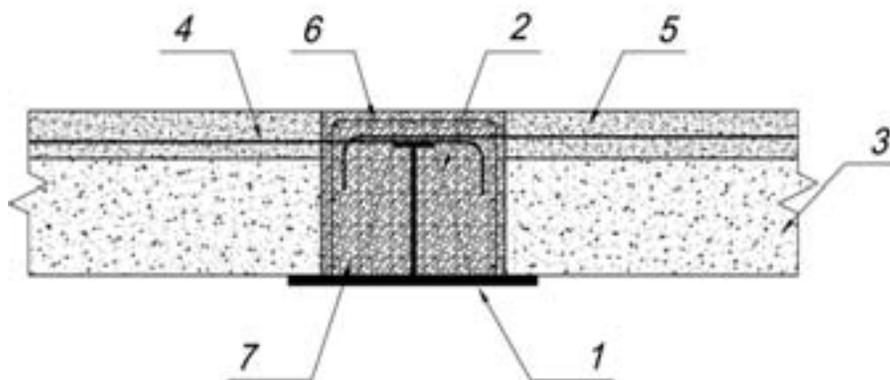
Узел опирания газобетонных плит перекрытия на несущий ригель: 1 — стальной составной профиль; 2 — ребра жесткости; 3 — газобетонные плиты; 4 — арматурные стержни в межплитных швах; 5 — бетон (раствор) замоналичивания межплитных швов; 6 — арматурная сетка; 7 — бетон замоналичивания несущего ригеля
